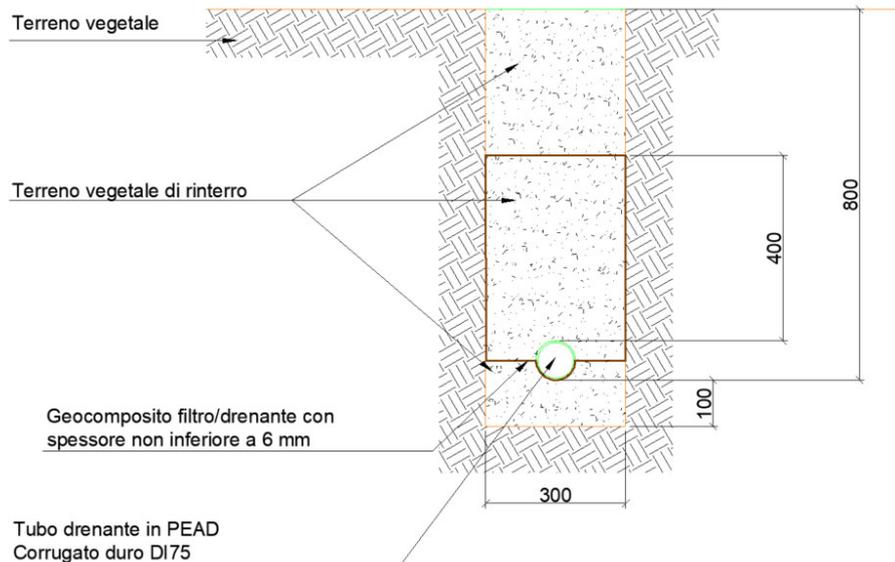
Sezione trincea drenante con tubazione DI 75 e riempimento dello scavo con terreno vegetale
